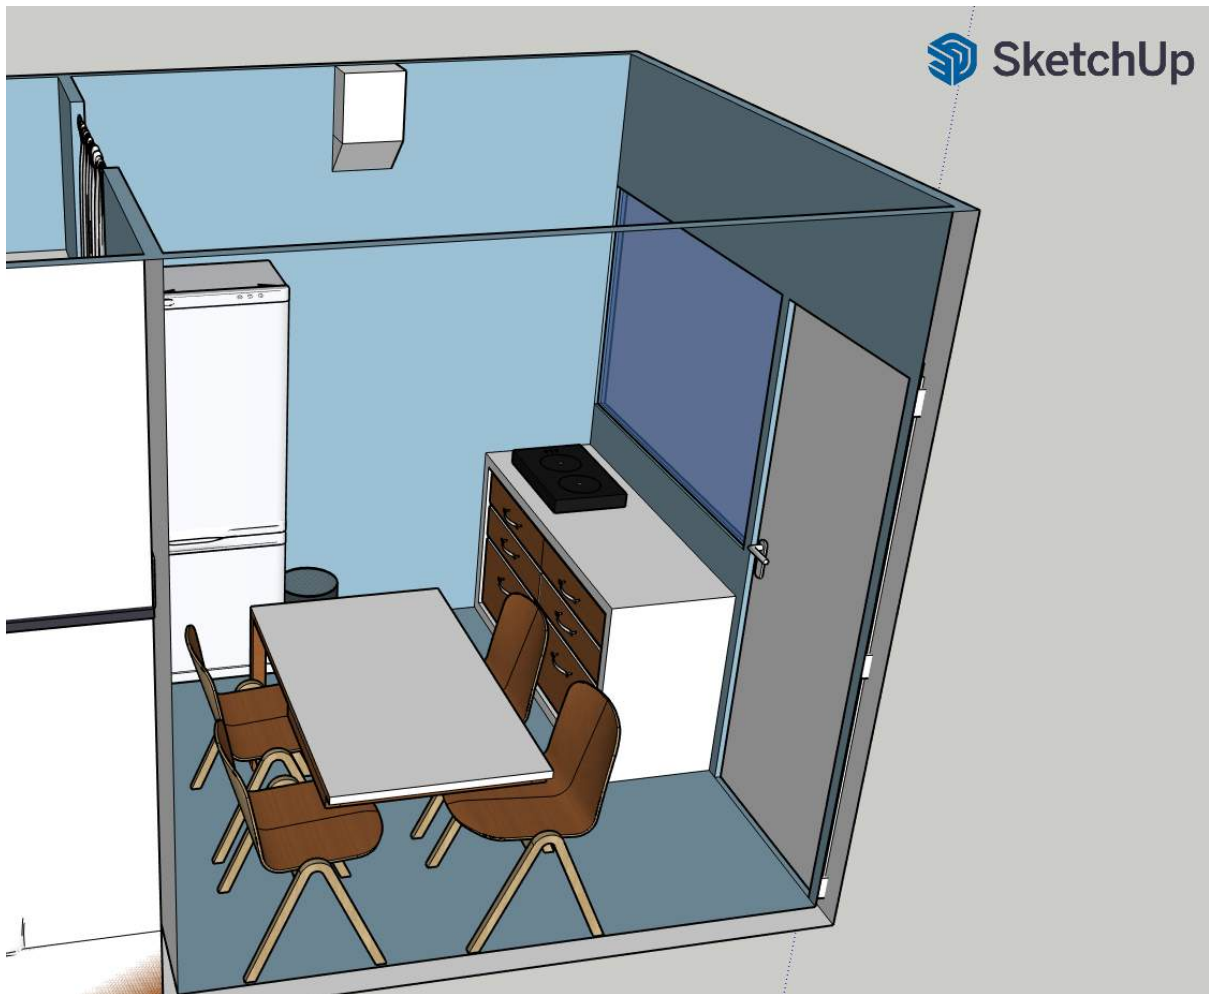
Bovenaanzicht vanuit slaapruimte 2
